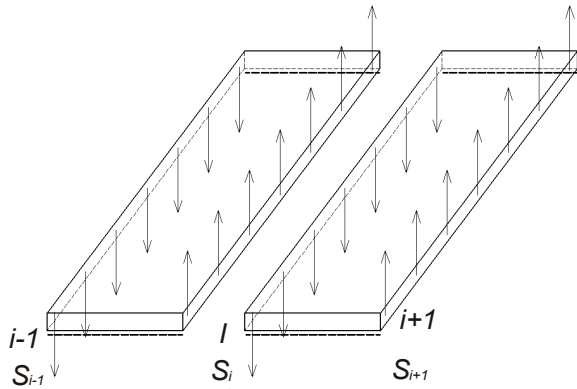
Схема членування сталезалізобетонного безбалкового перекриття на лінійні елементи.
